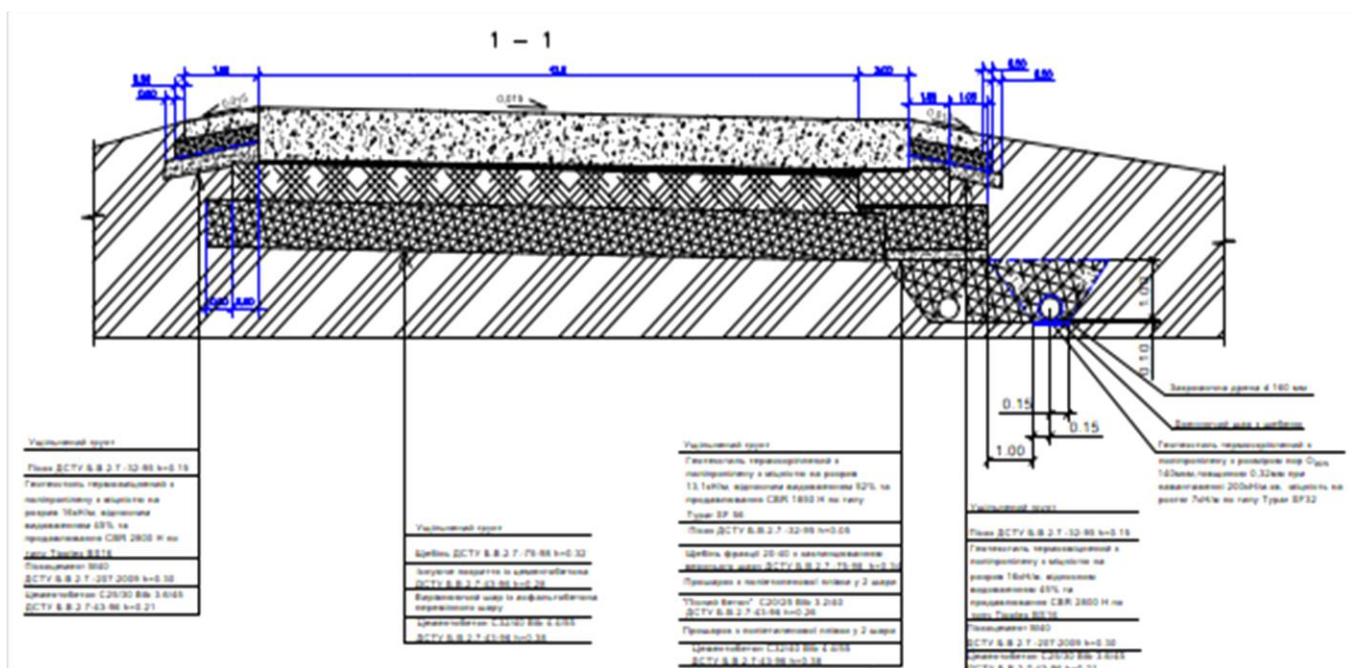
Обраний варіант конструкції покриття ШЗПС
